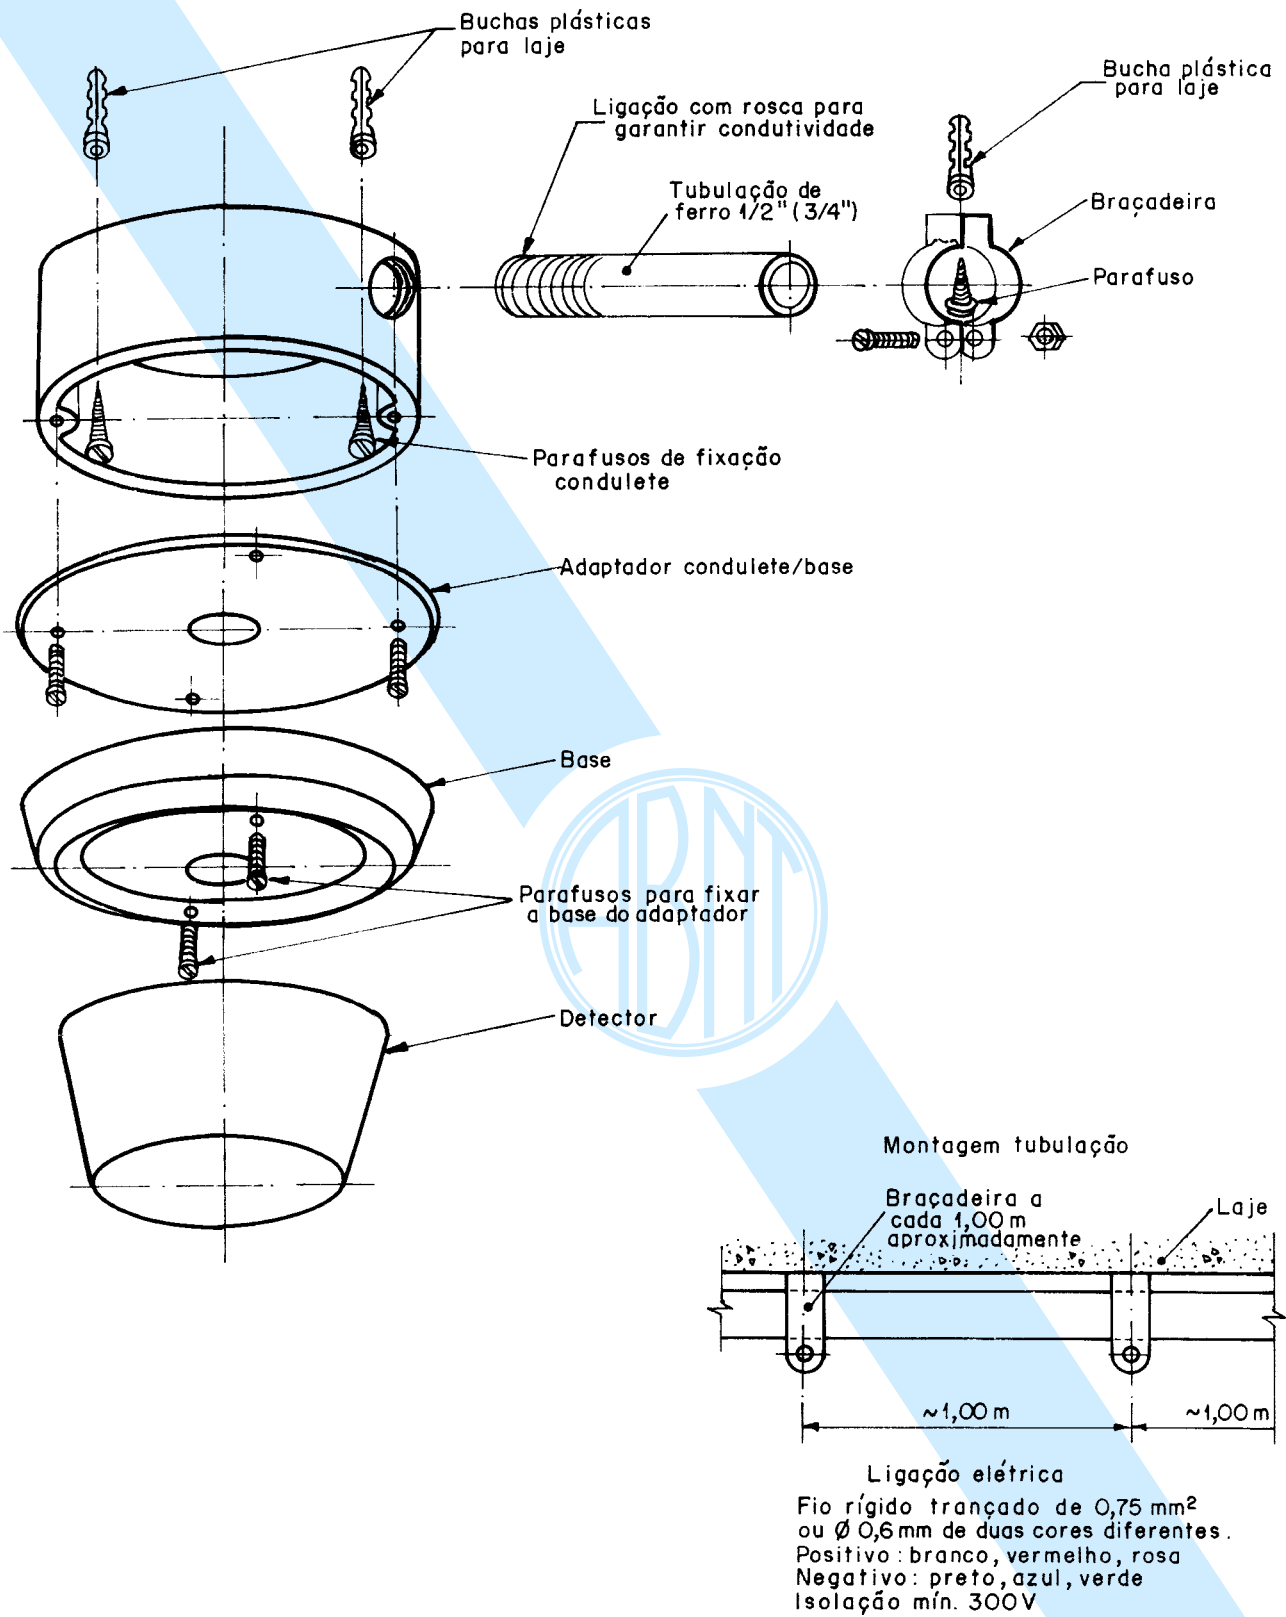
Desenho explodido da montagem do detector com tubulação de ferro
